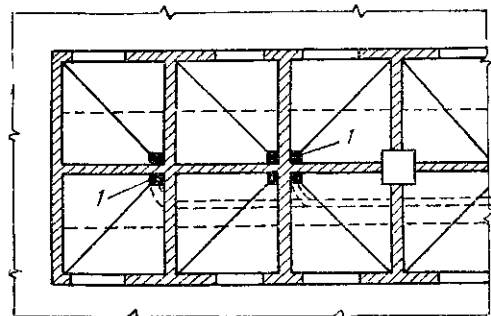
Схема устройства душевых помещений на первом этаже
